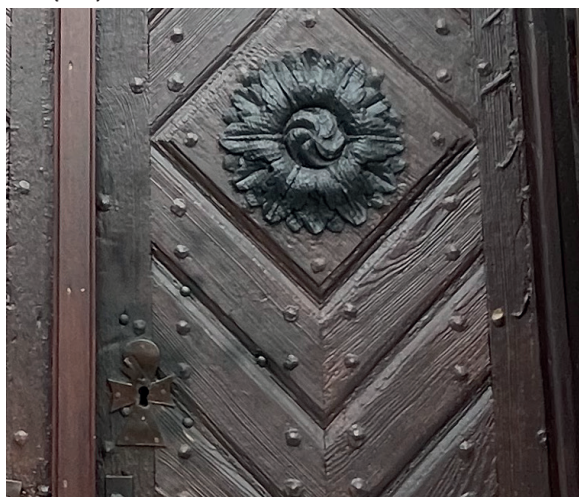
Elewacja zachodnia; historyczne drzwi w części południowej zachowane w dobrym stanie technicznym.
